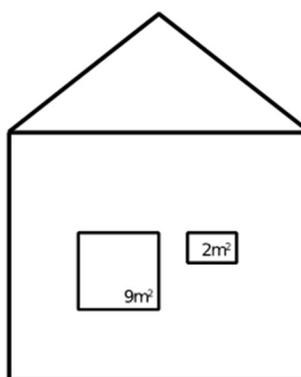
exemple d'une construction en panneaux de bois contrecollés
